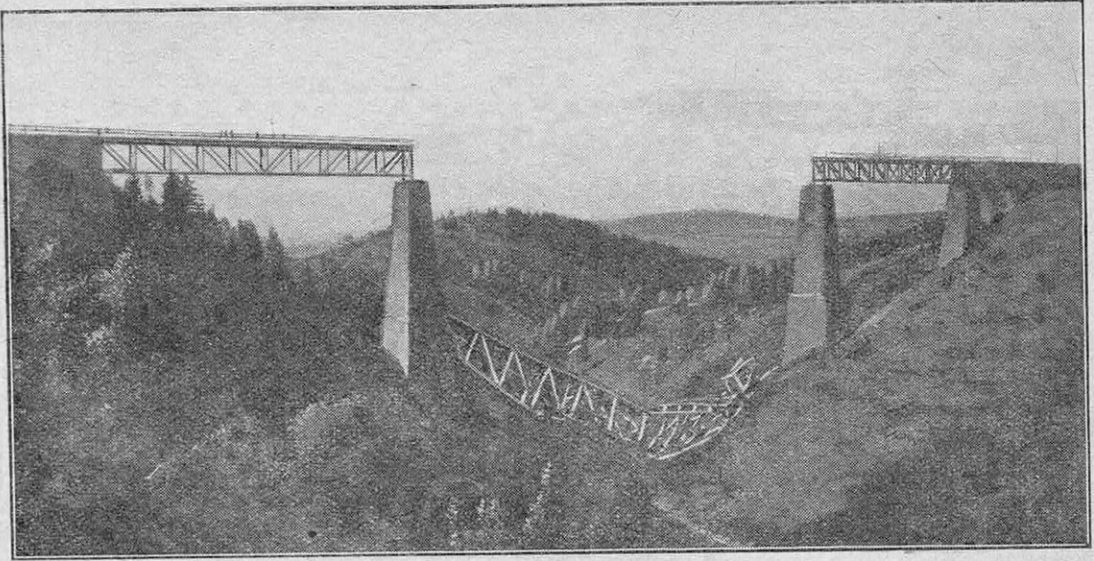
EXEMPLE DE DESTRUCTION D'UN PONT A POUTRES DROITES ET BÉQUILLES EN BÉTON ARMÉ
